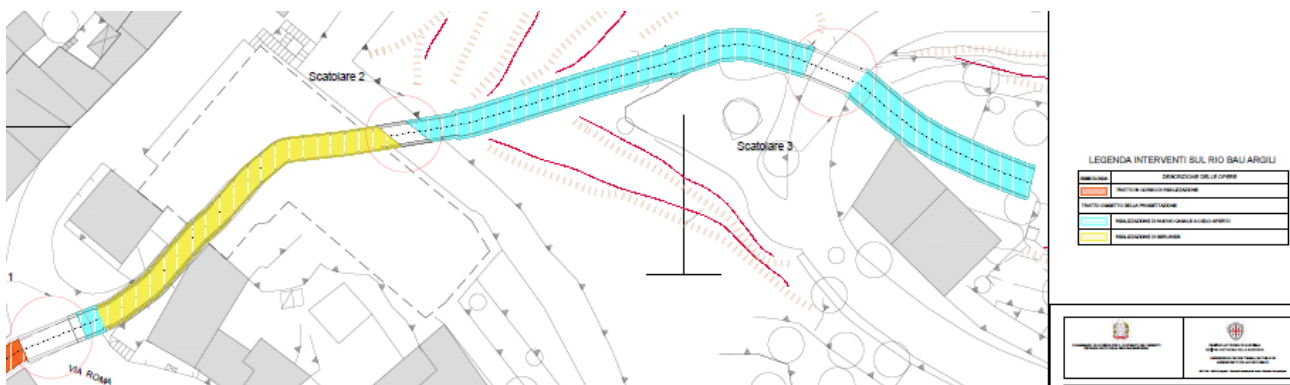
Rio Bau Argili – Planimetria interventi in progetto
